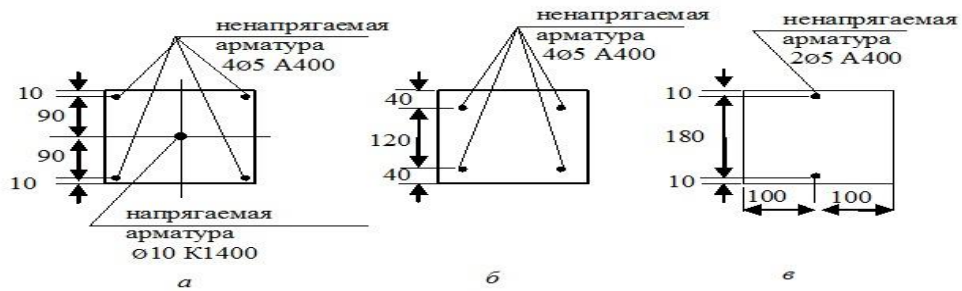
Схемы армирования: а – нижний пояс, б – верхний пояс, в - решетка
